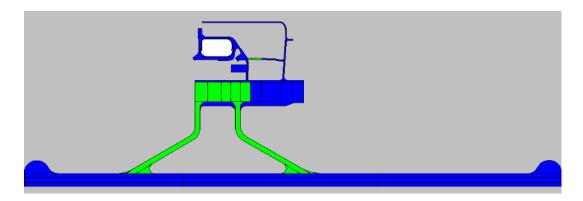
Plano de pavimentos acorde al tipo de pavimento en ZIH
